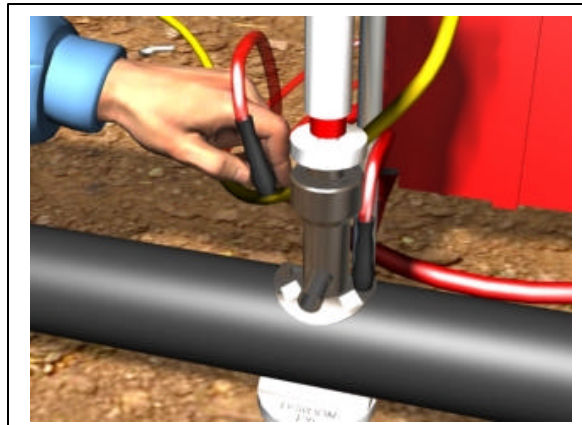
O cabo da máquina deverá ser conectado aos bornes do tê.
